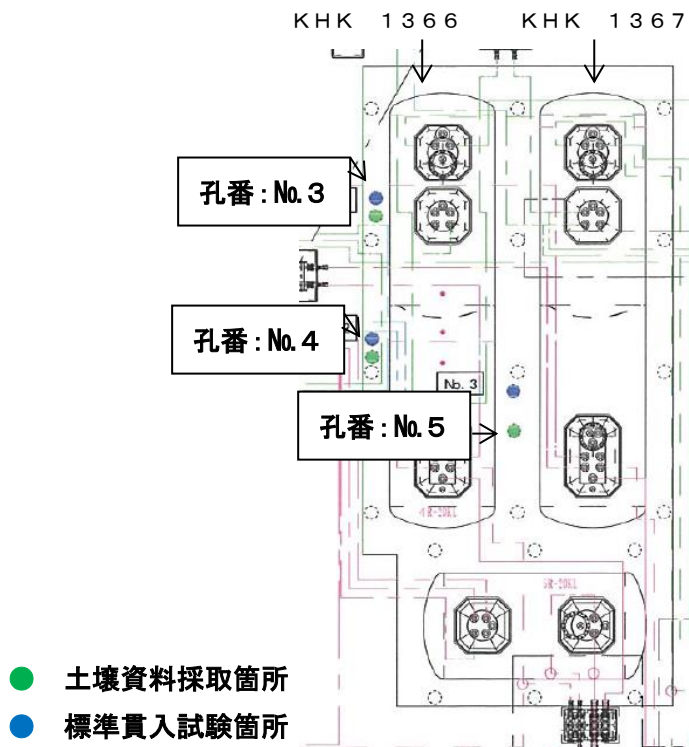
1. 2 ボーリング実施箇所平面図 (①)
